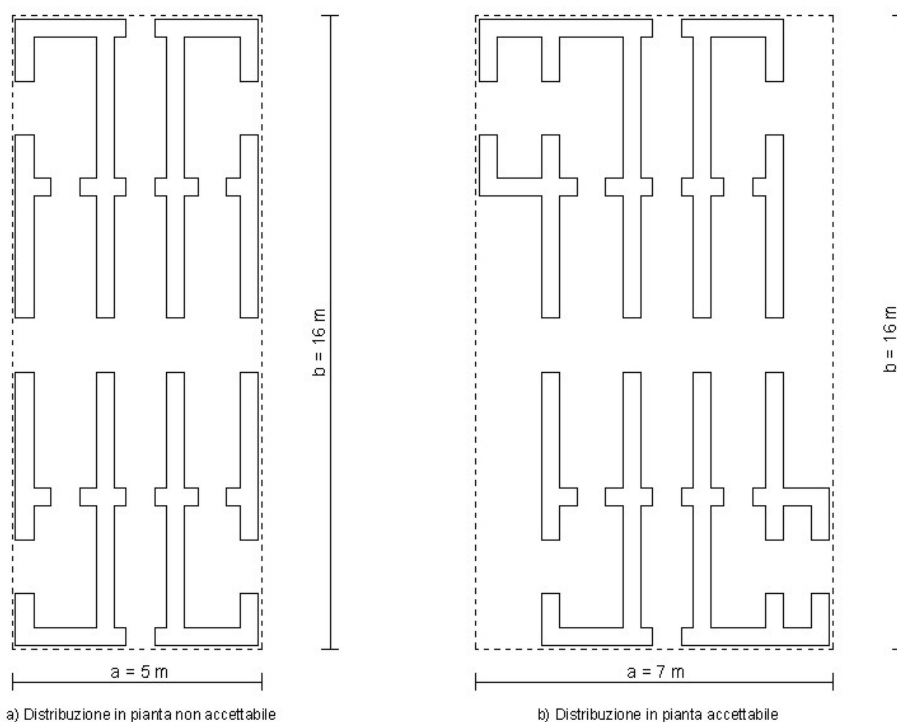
a) Distribuzione in pianta non accettabile; b) Distribuzione in pianta accettabile
